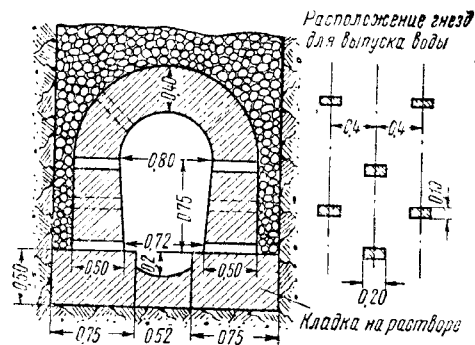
Конструкция фильтра с глинобетонным лотком
